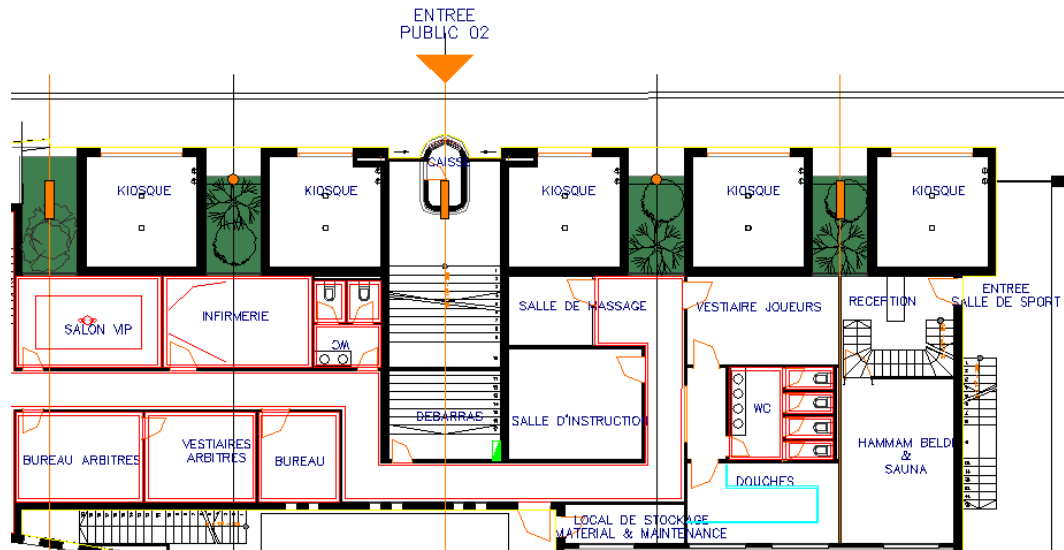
Plan du rez-de-chaussée de la tribune gauche
